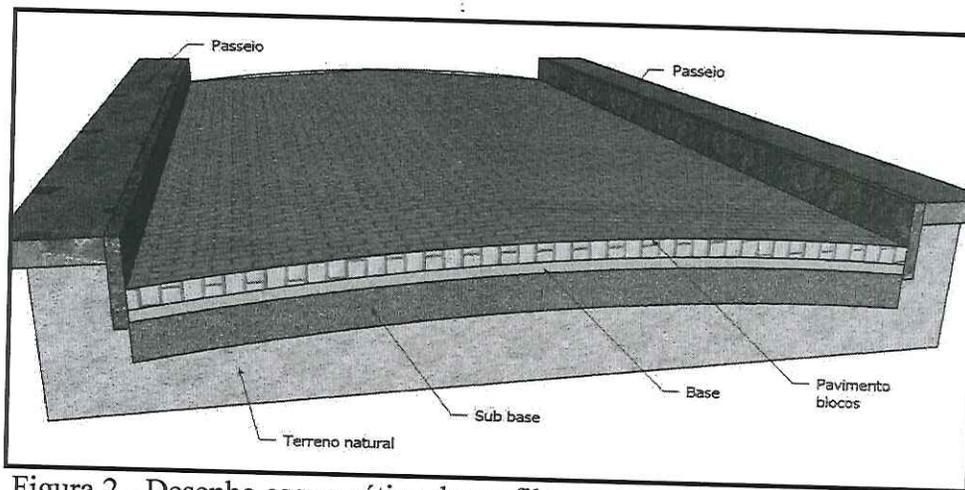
Desenho esquemático do perfil transversal da pavimentação
